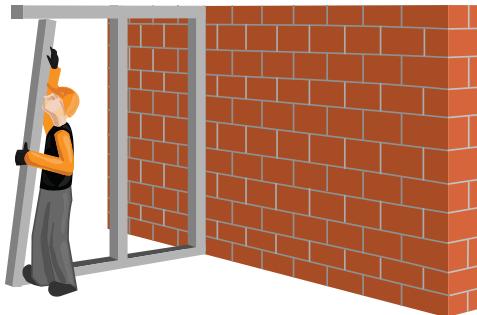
Приклейка и схема расположения уплотнительной ленты в каркасе
